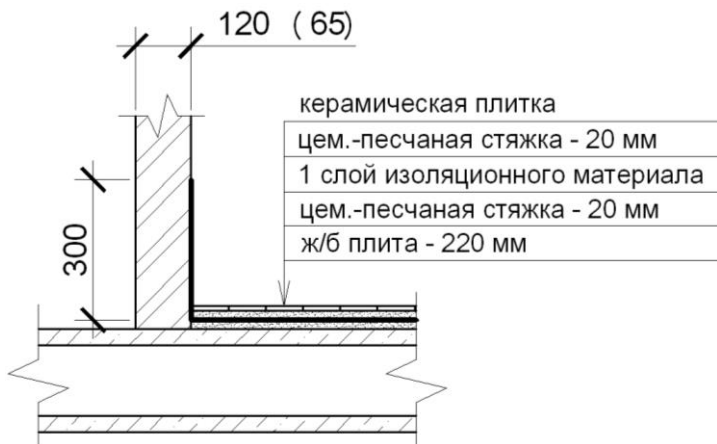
Междуетажное перекрытие в помещениях с повышенной влажностью
